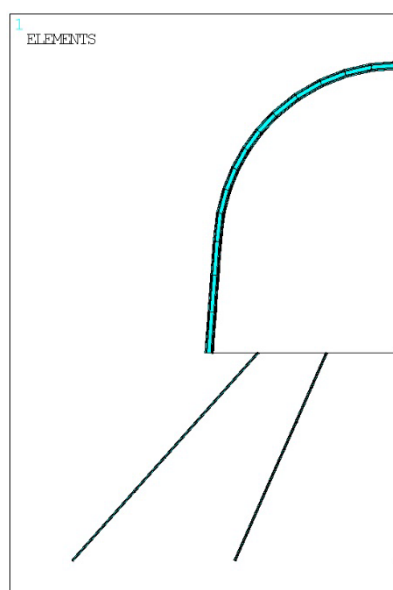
Схема кріплення штреку анкерним кріпленням
